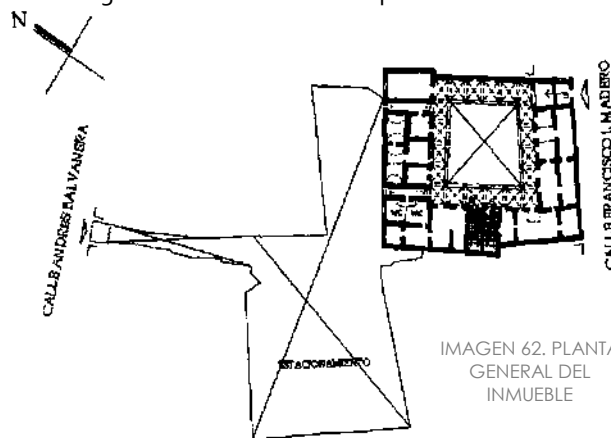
PLANTA GENERAL DEL INMUEBLE
